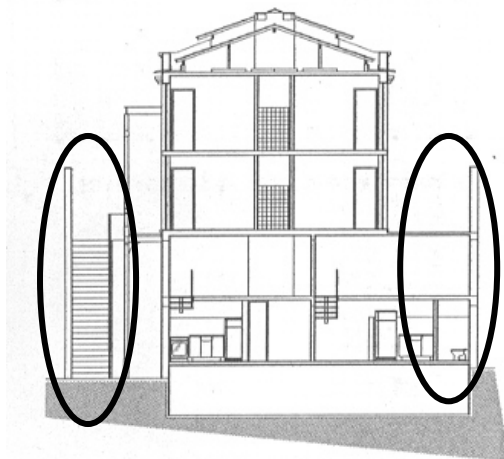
Corte transversal da edificação à rua Francisco Muratori, 38. Observar que a edificação encosta-se aos muros divisórios do terreno (SECRETARIA, 2000, p. 74).
